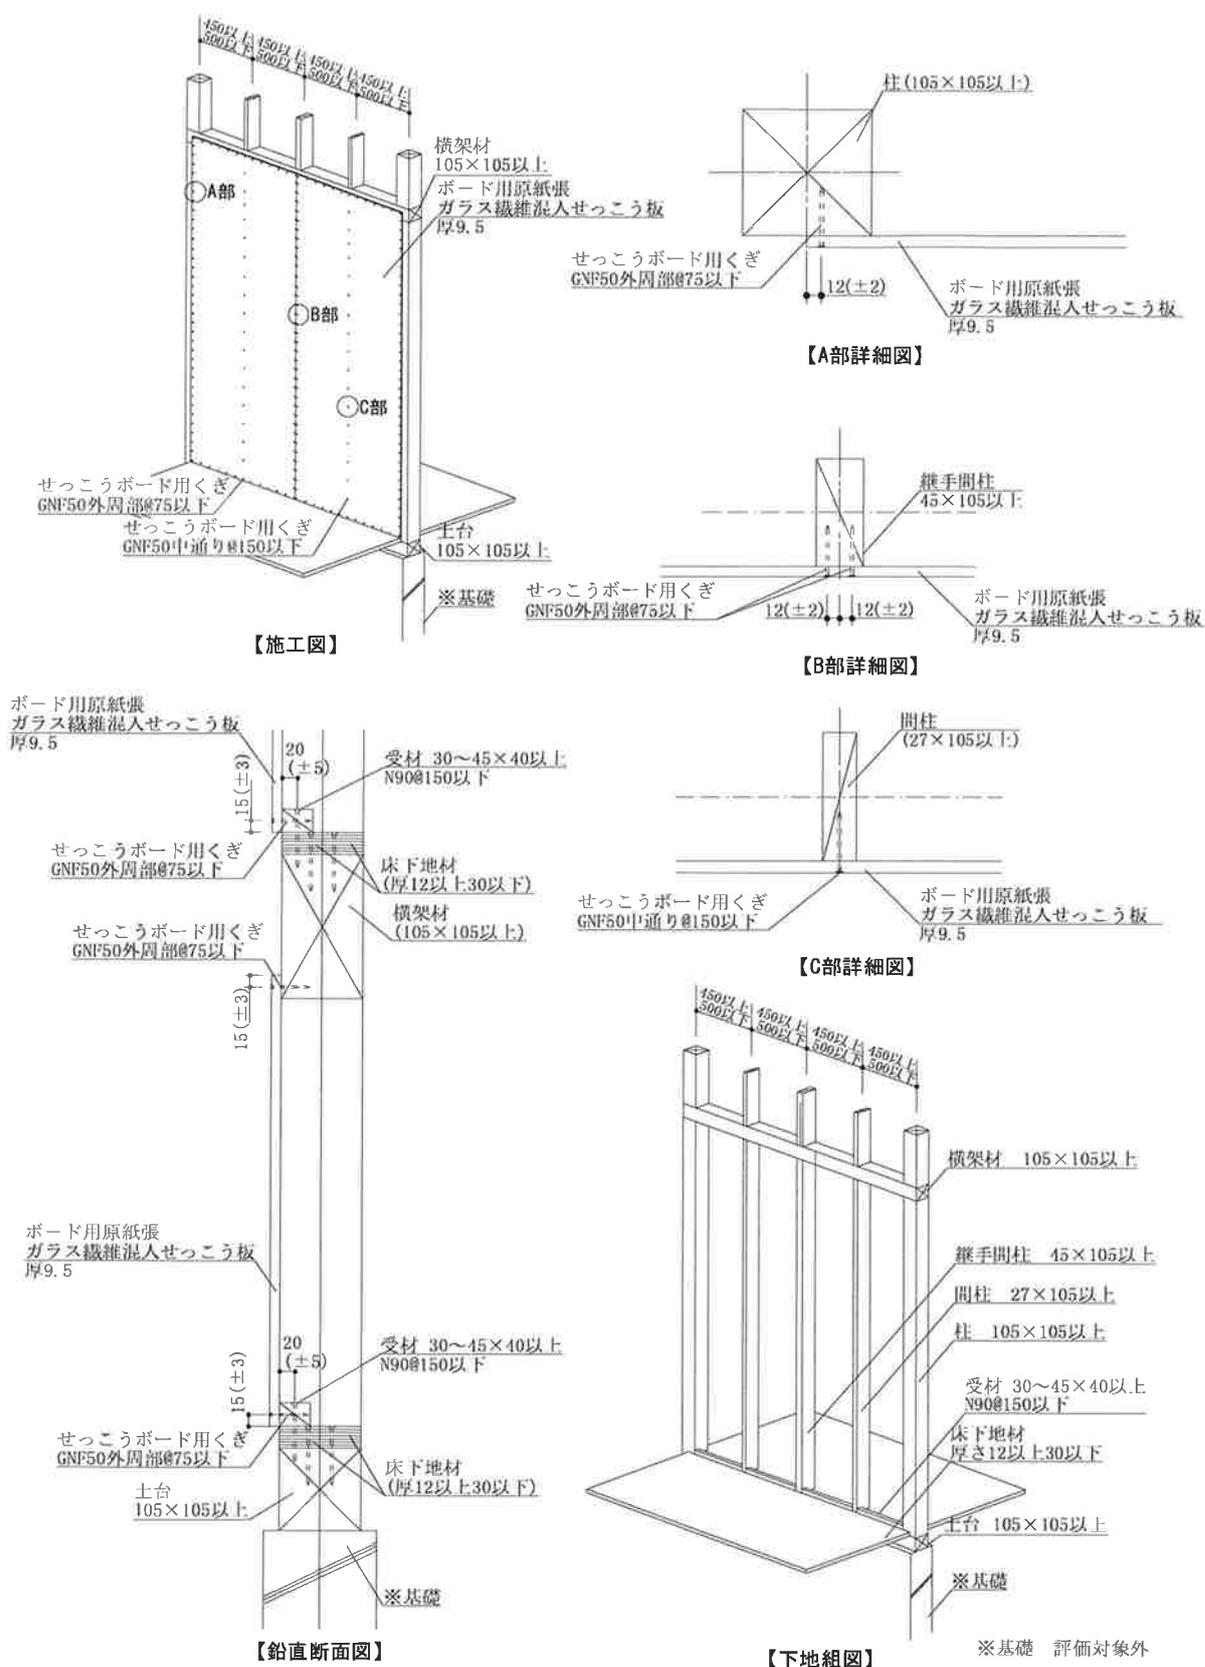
施工詳細図：1枚張りの場合 (寸法単位：mm)
